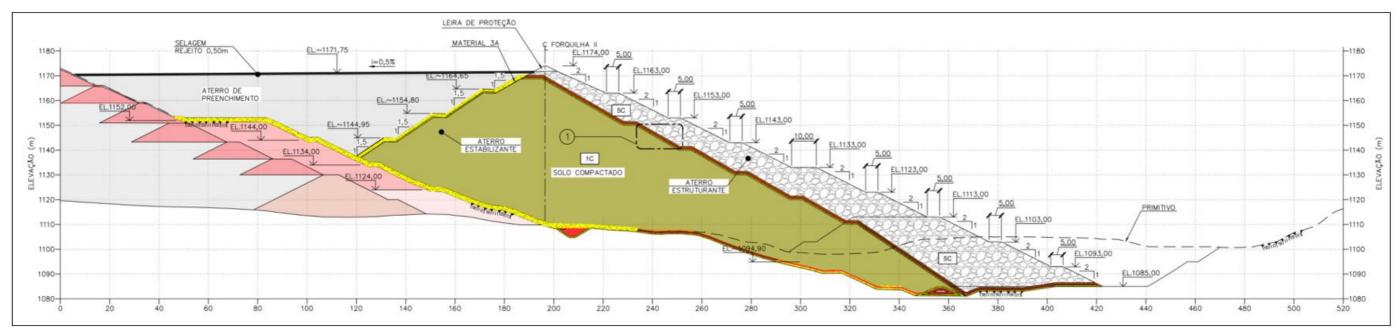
Geometria de descaracterização - Seção transversal - Forquilha II (Fonte: 1850HH-X-41369 - Intertechne)
